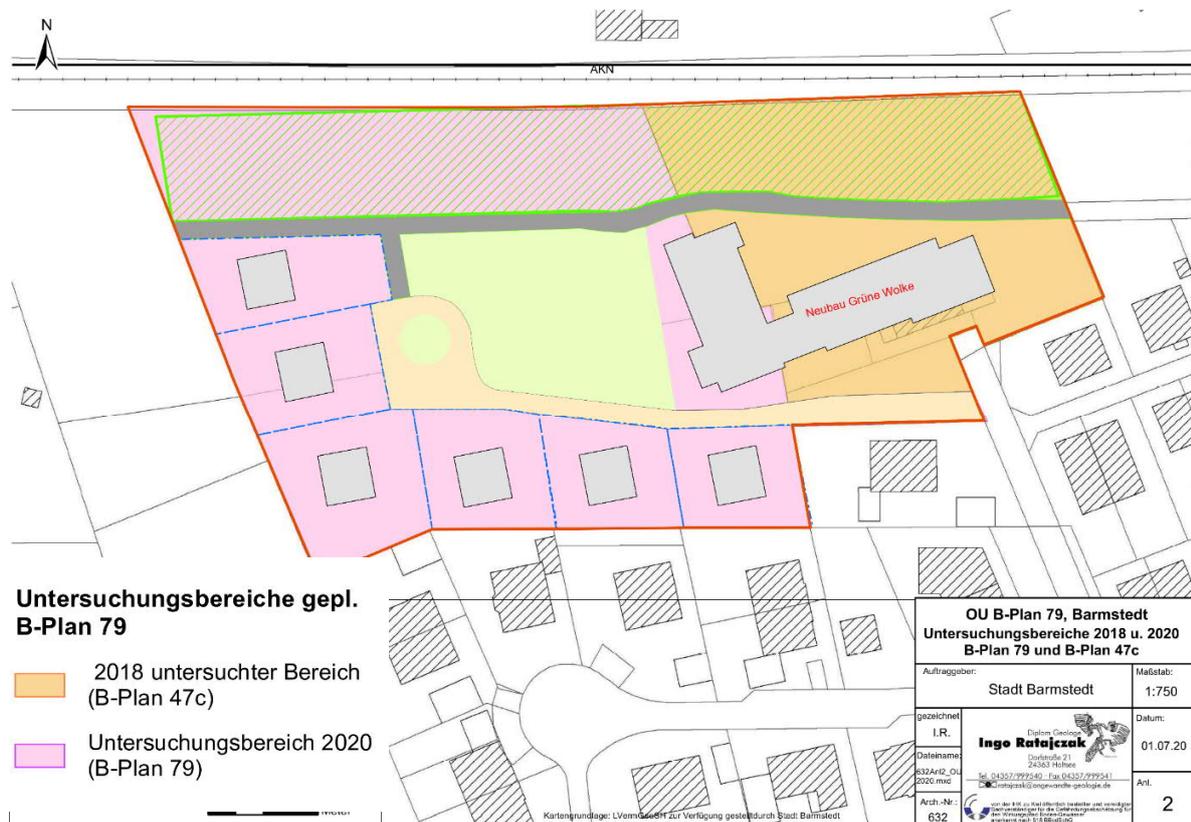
Übersichtsplan der beiden Orientierenden Erkundungen
